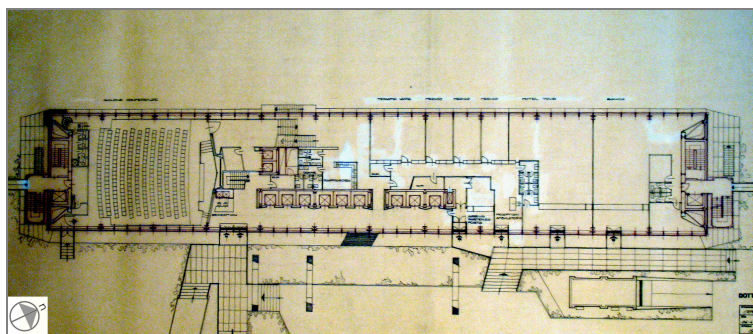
proposta di ristrutturazione generale – pianta piano terra – variante n°1
